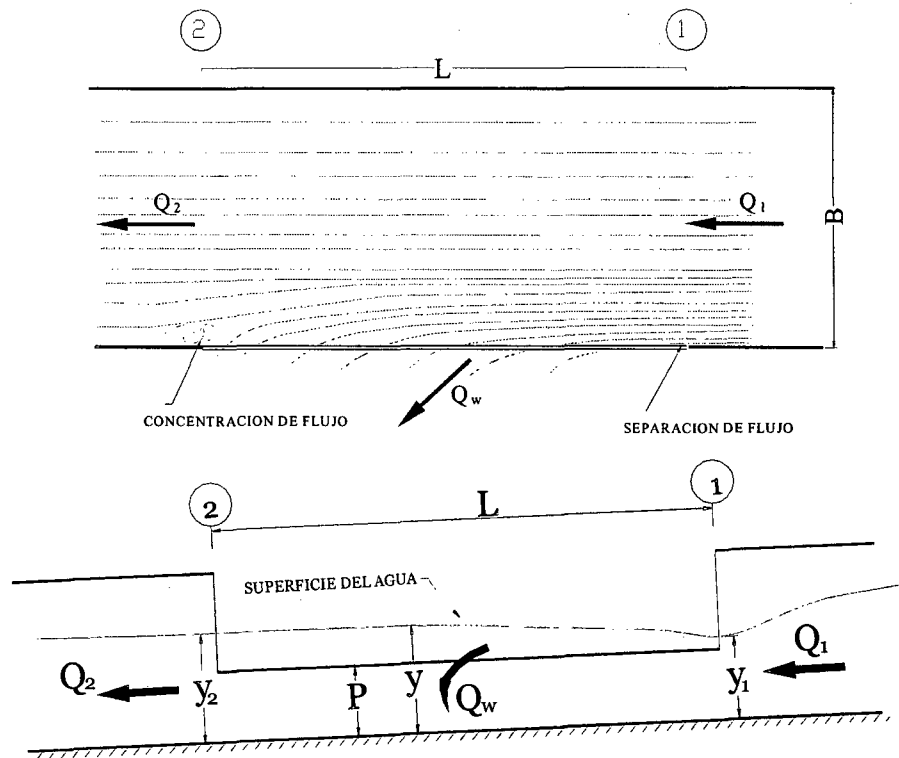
Esquema de un vertedero lateral vista en planta y perfil.
